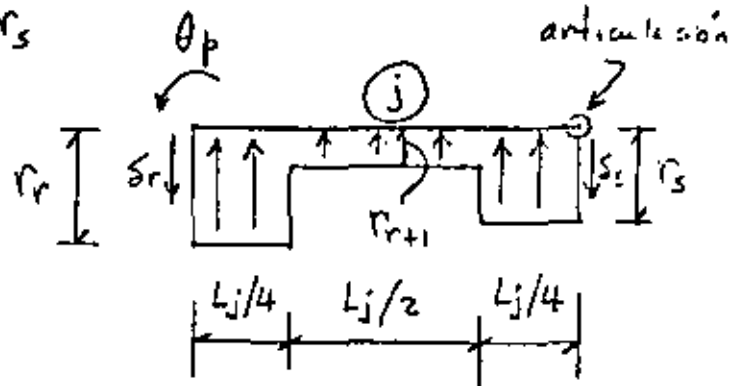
Barra con cargas repartidas en la cimentación. Apoyo continuo a la izquierda y apoyo articulado a la derecha.
